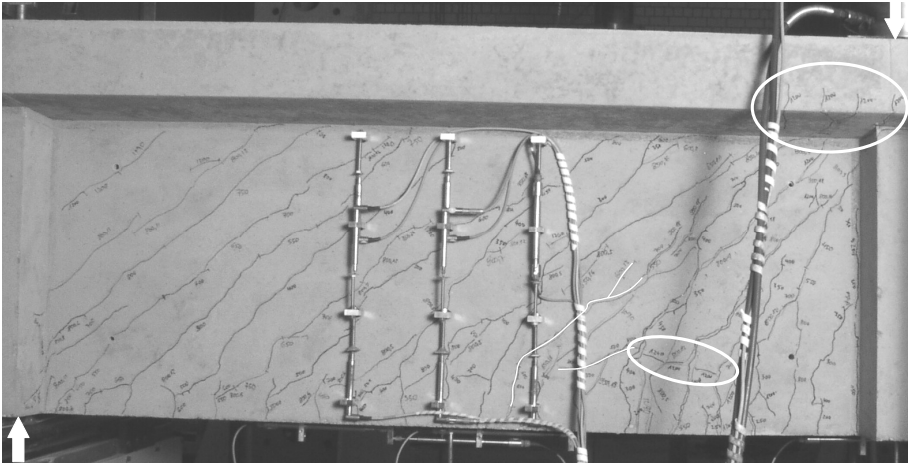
Abschließendes Rissbild mit Einschnürung der Druckzone in Feldmitte und horizontalem Riss in Höhe der 3. Bewehrungslage (Ansicht der Trägerrückseite).
